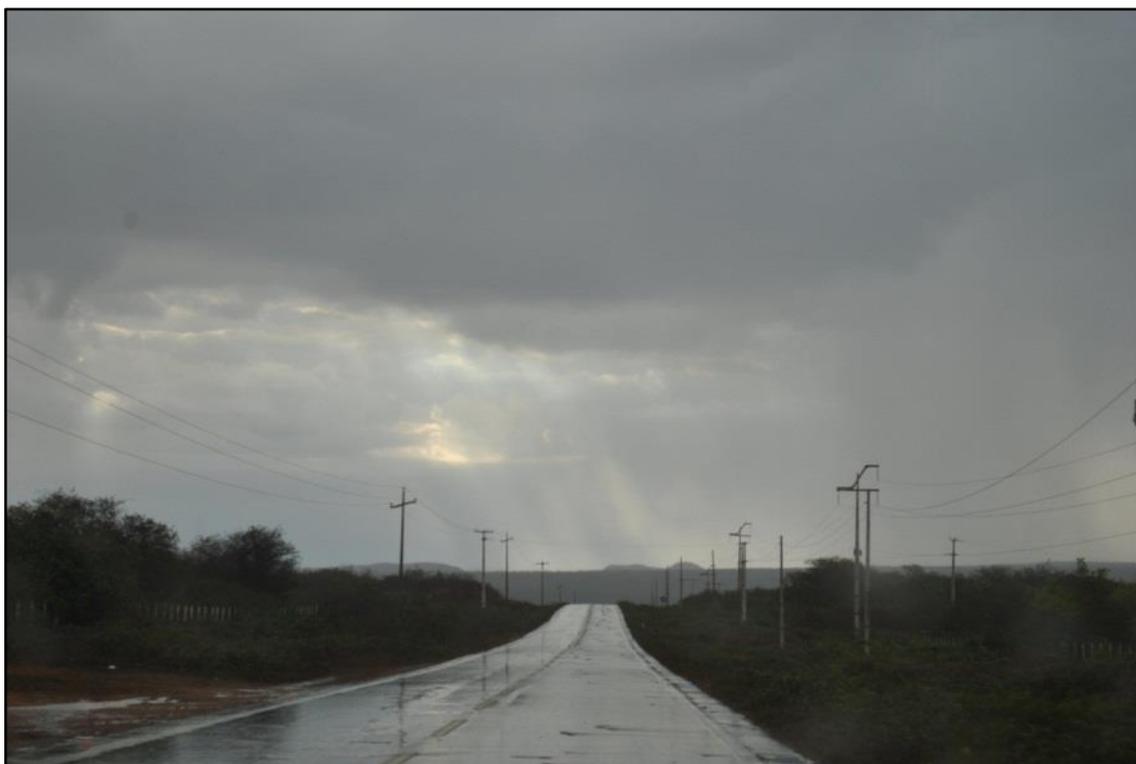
CE-187 (ENTRE TIANGUÁ E VIÇOSA)
